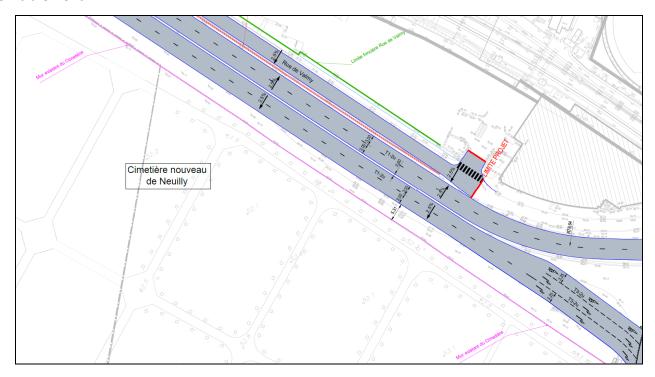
Vue en plan localisant le mur du cimetière de Neuilly au sud de la RD 914
